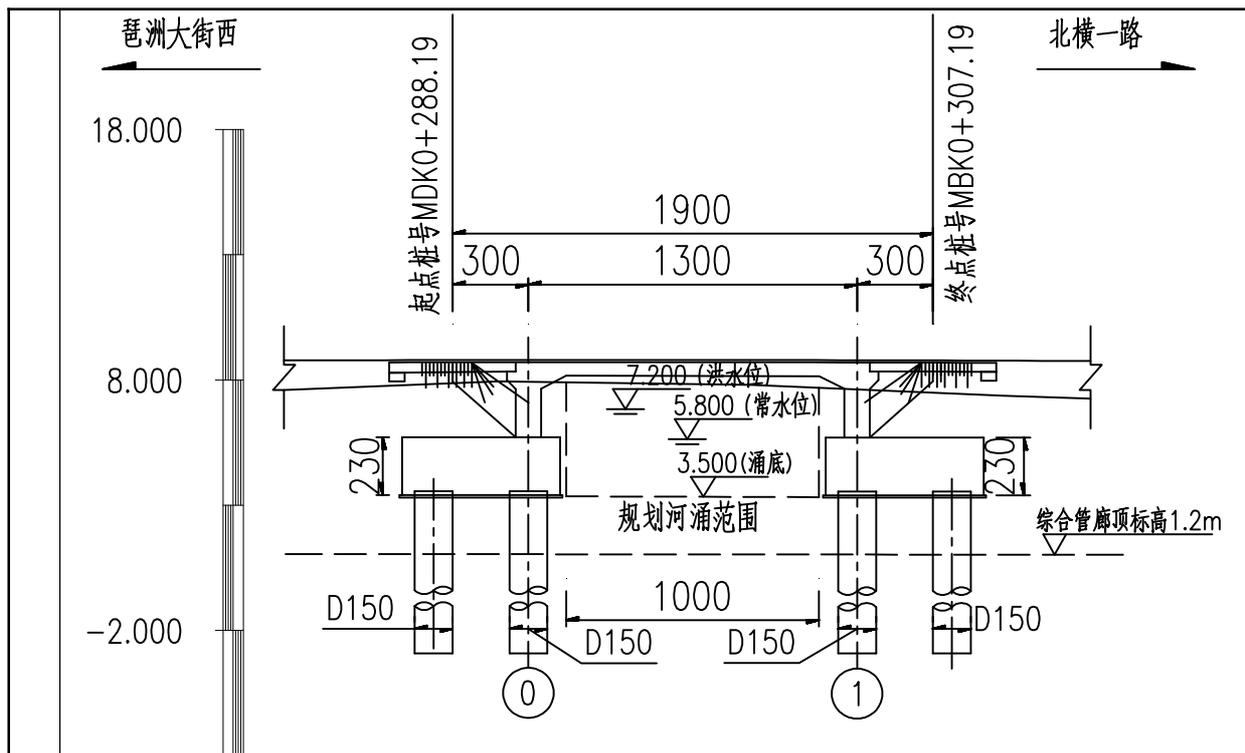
磨碟沙路小桥立面图 (单位: cm)
